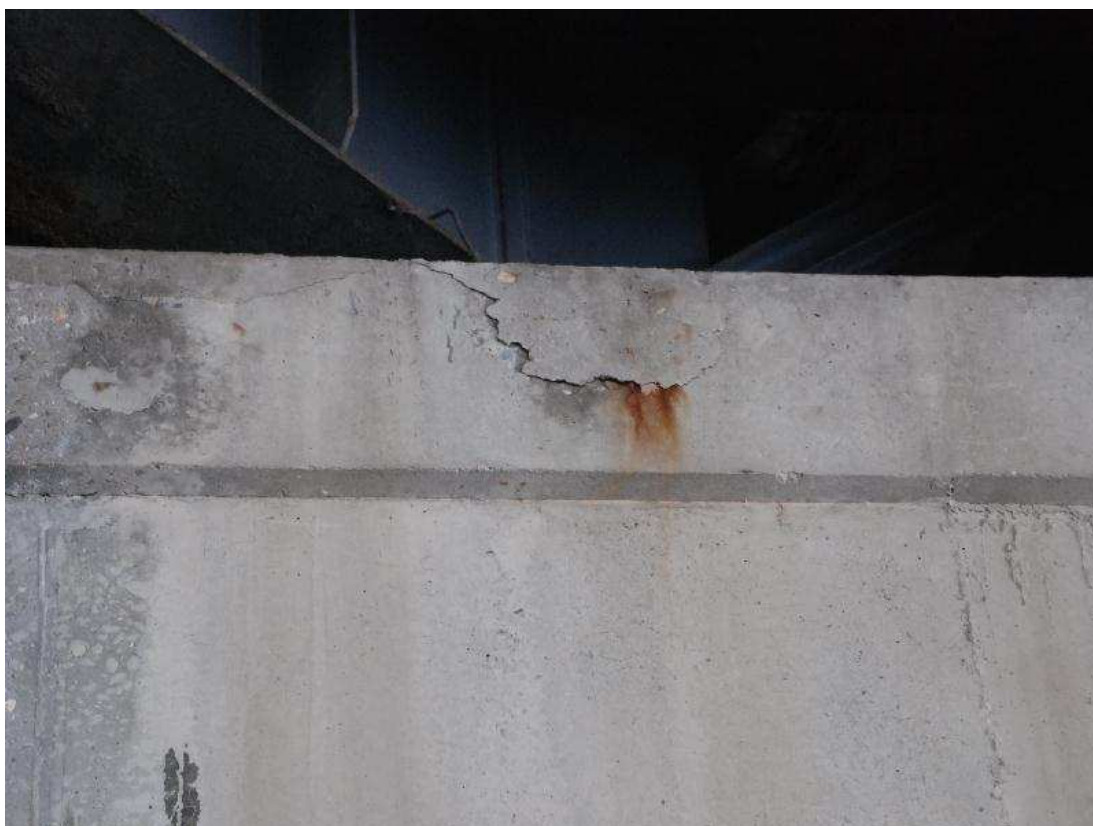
Gros encrassement du sommier de la culée Ouest.
